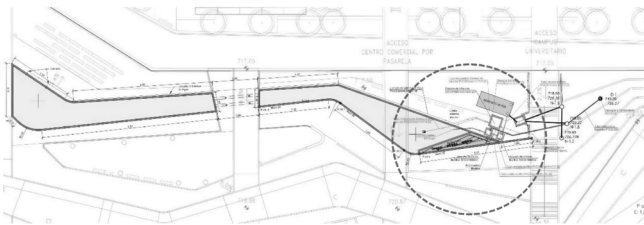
Plano detalle Lámina de agua y Biofiltro Parque Caleido. (Reproducido con permiso de FIA, Fenwick Iribarren Architects).
